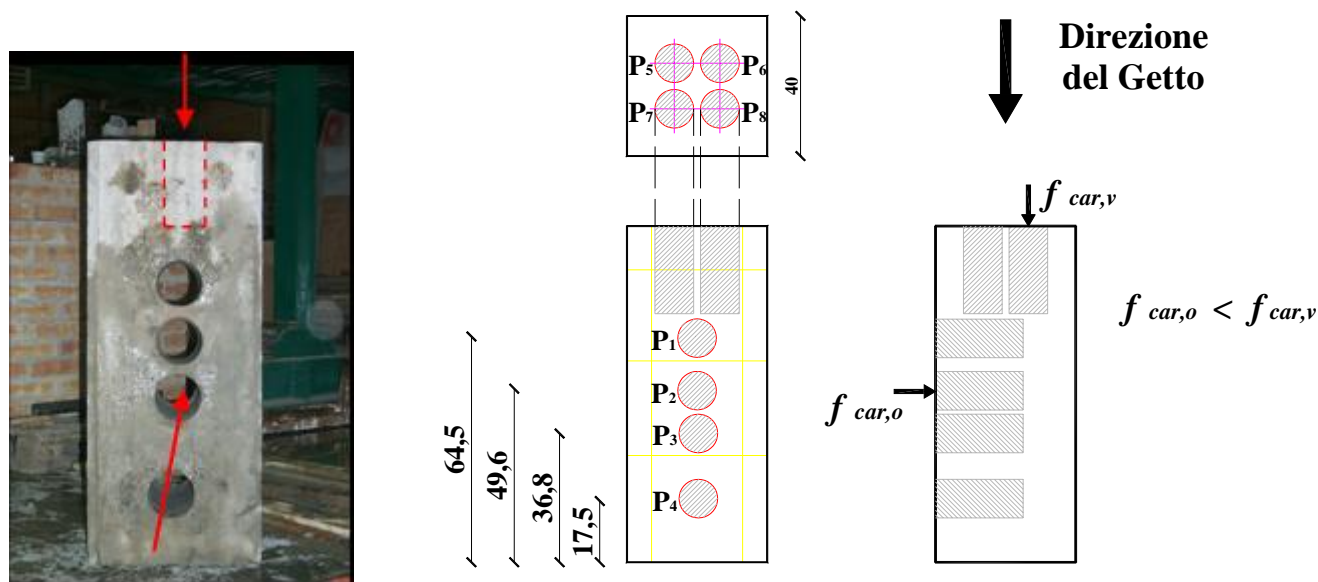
Distribuzione delle campioni estratti dalla trave T\_A
